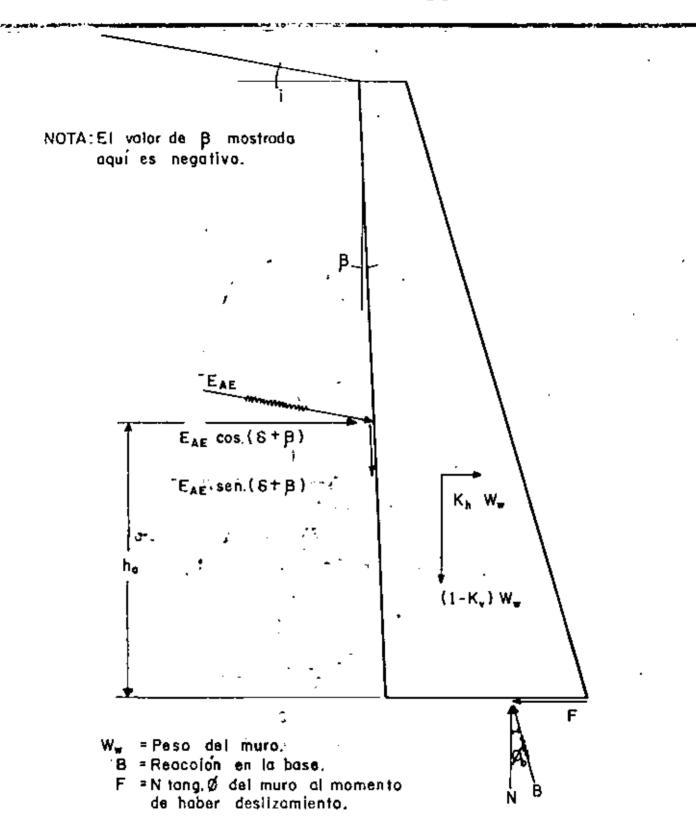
FUERZÁS SISMICAS EN UN MURO DE RETENCION POR GRAVEDAD. (Ref. 9)
